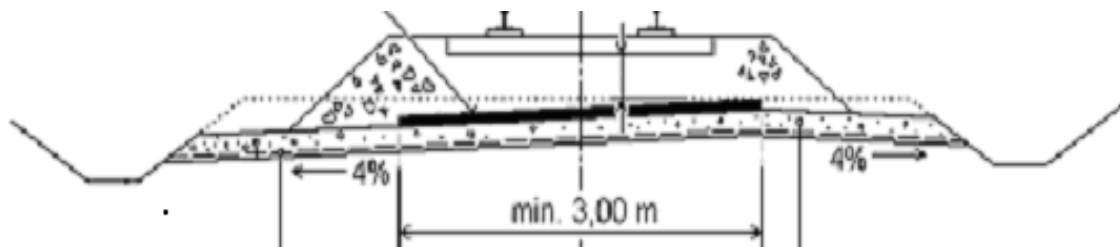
Конструкція нижньої будови залізничної колії із застосуванням підбаластних залізобетонних плит
